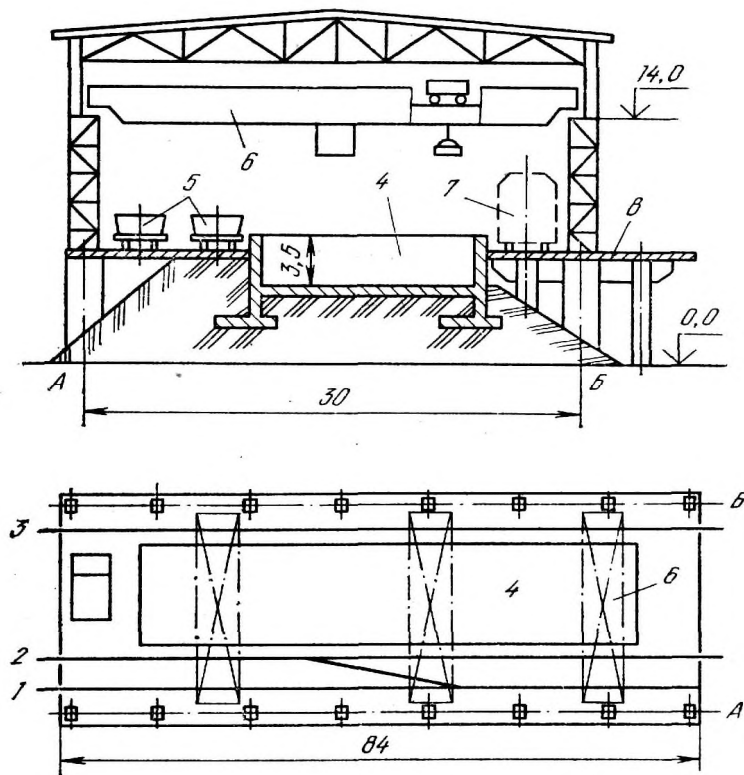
План и поперечный разрез верхнего шихтового отделения для магнитных материалов
